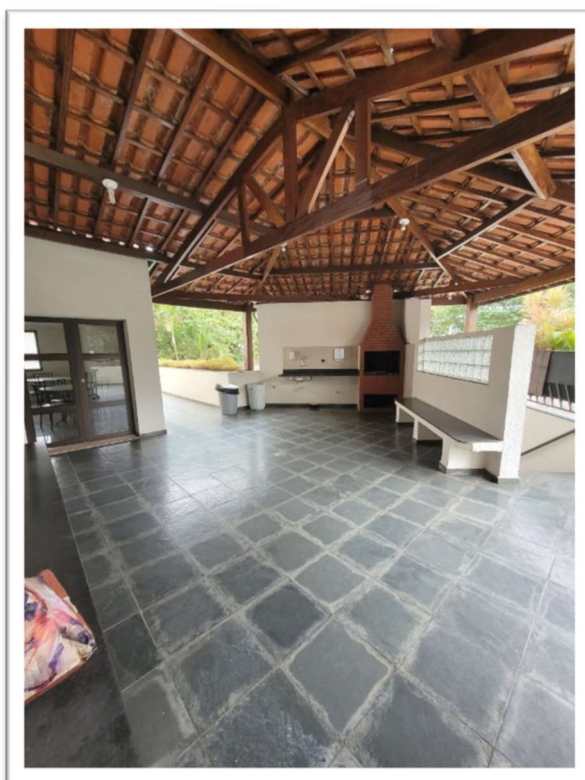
ESPAÇO COM CHURRASQUEIRA
